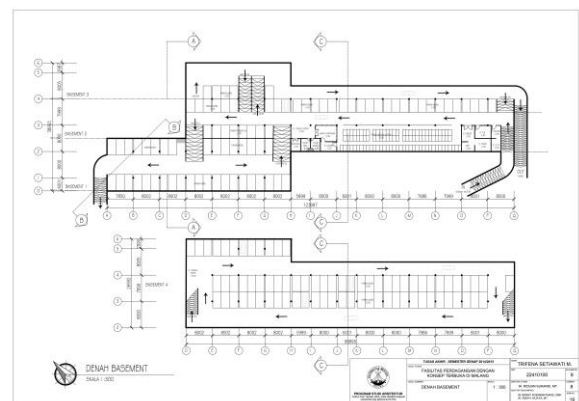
Denah *Layoutplan*. Sumber: penulis
